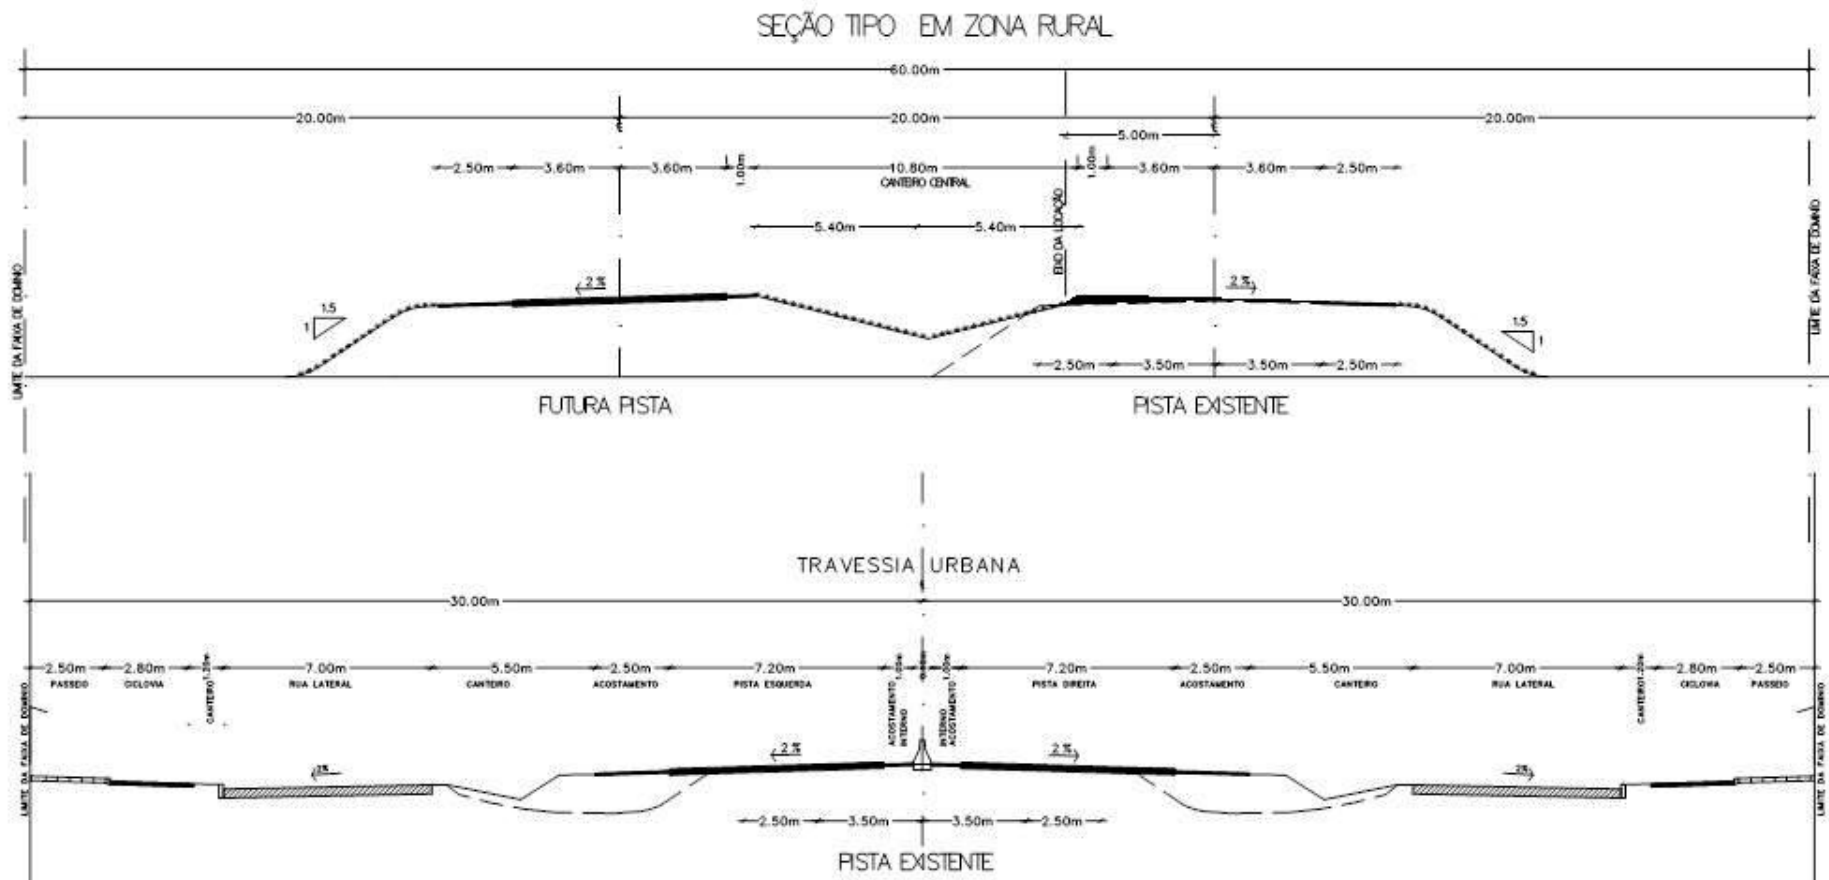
Seção tipo em zona rural e travessia urbana - Lote 1
